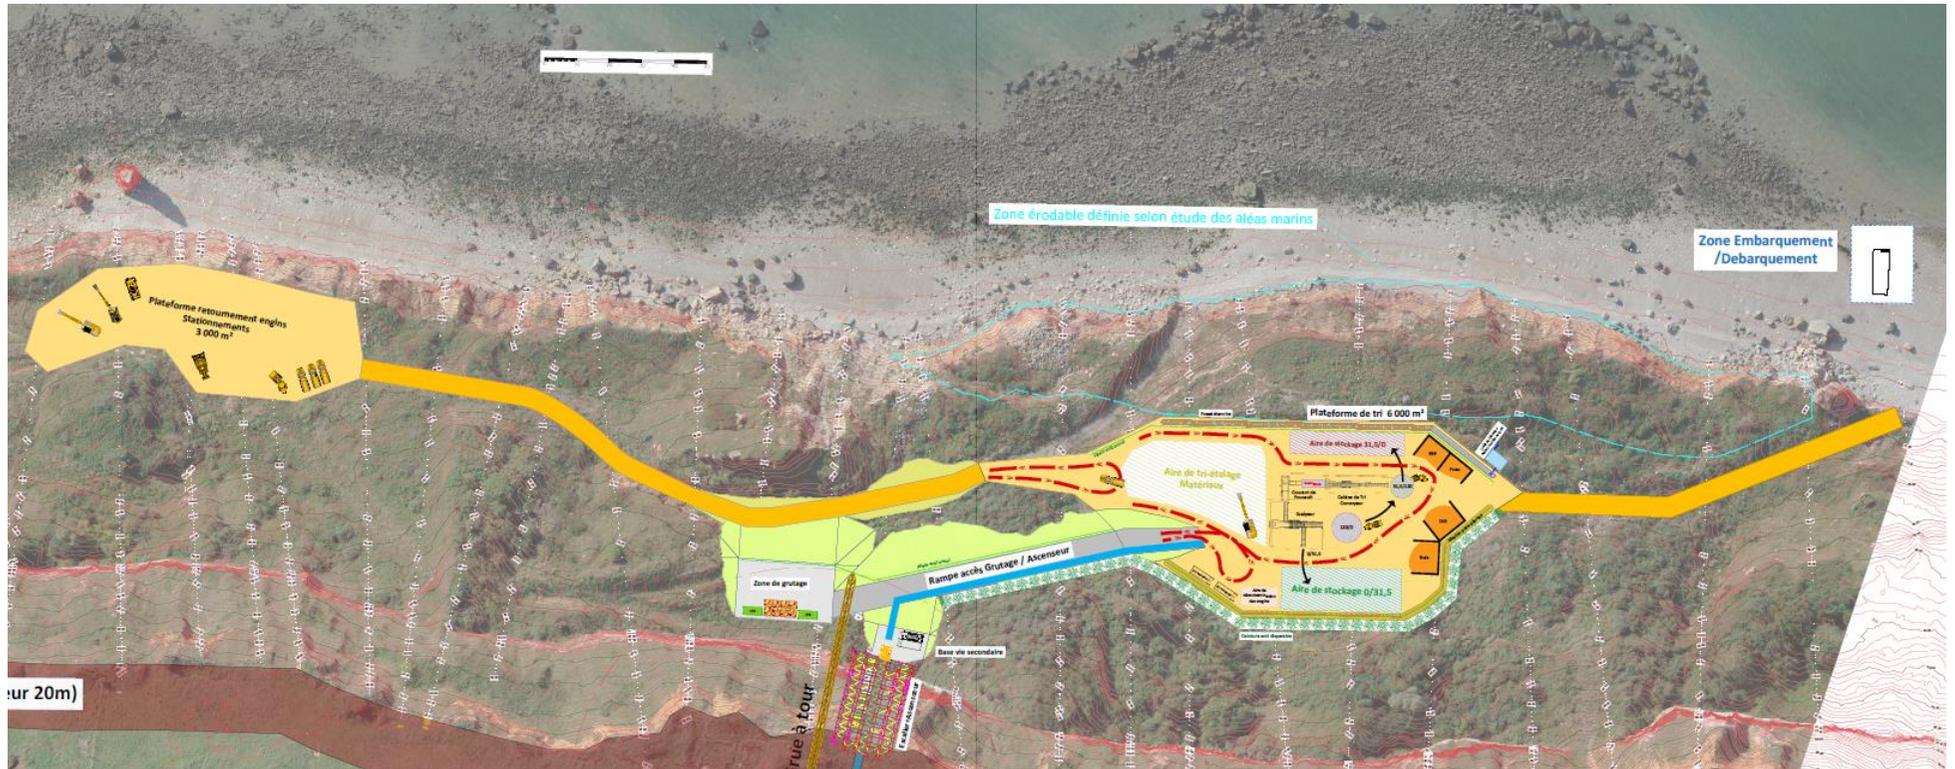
Plan d'installation de chantier – plateforme basse (©Tersen)
